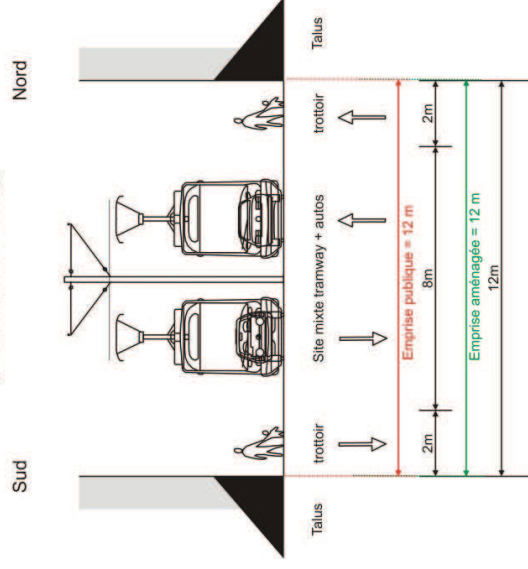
Situation projetée. Coupe du point dur d'insertion de la variante 5 rue de Mittelhausbergen : Pont ferroviaire
